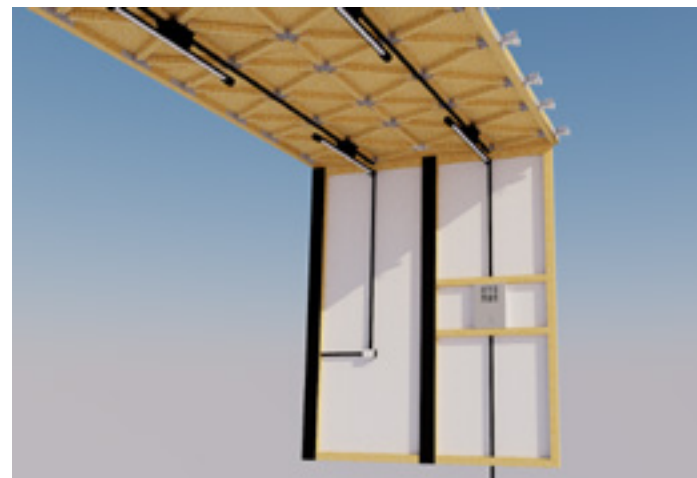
Passagem do conduíte interno da parede para aparente na laje
